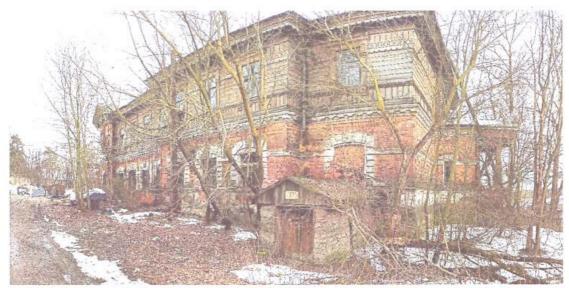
Вид на восточный фасад (с северо-восточного угла)
